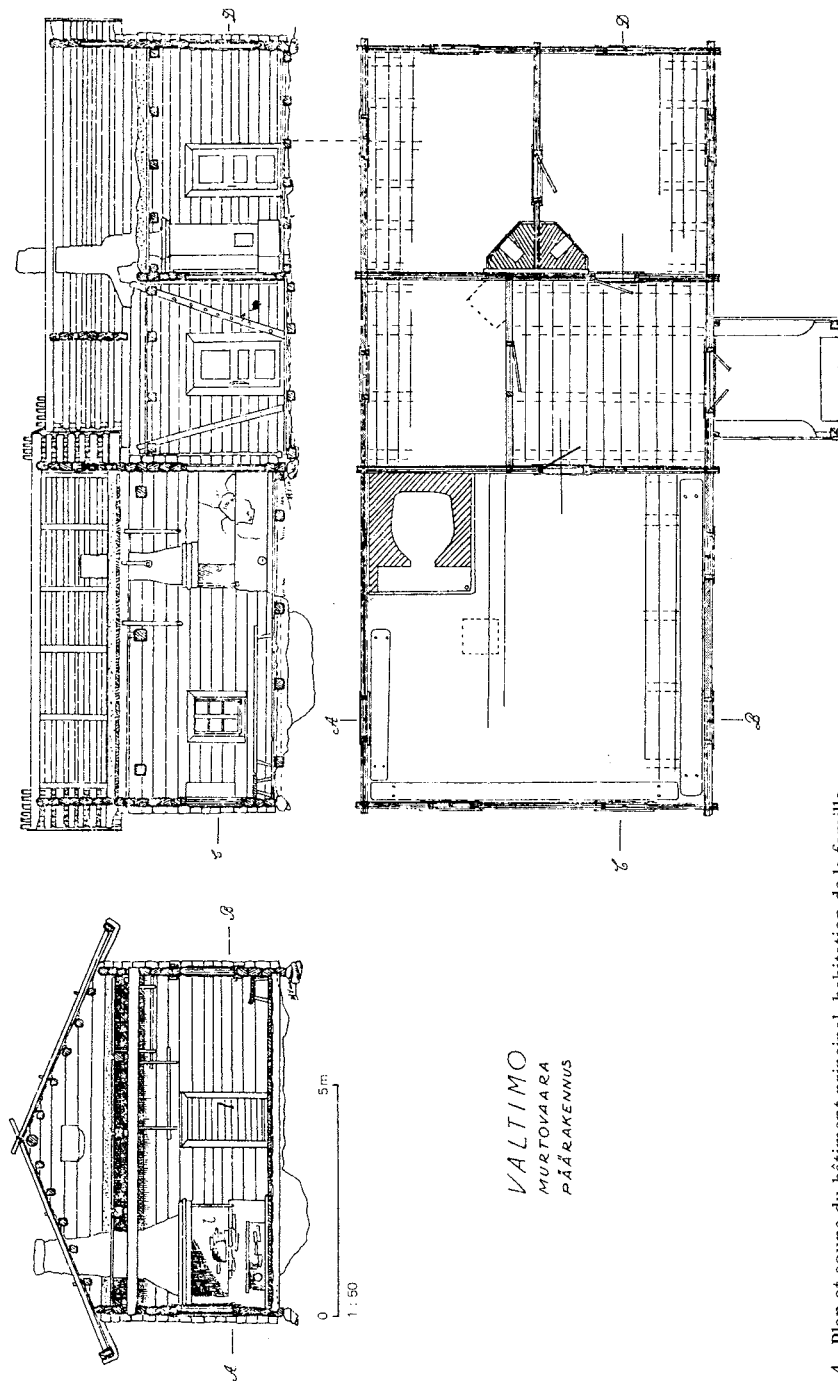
Plan et coupe du bâtiment principal, habitation de la famille.
